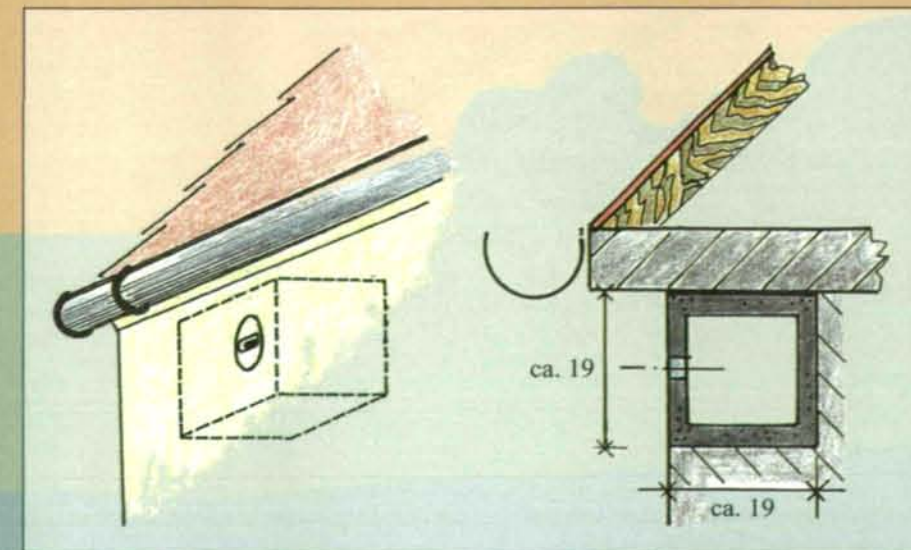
Eingemauerter Niststein aus Beton in der Außenmauer, im Schnitt und Schrägbild. Einschlußloch 3,5 x 6 cm.
